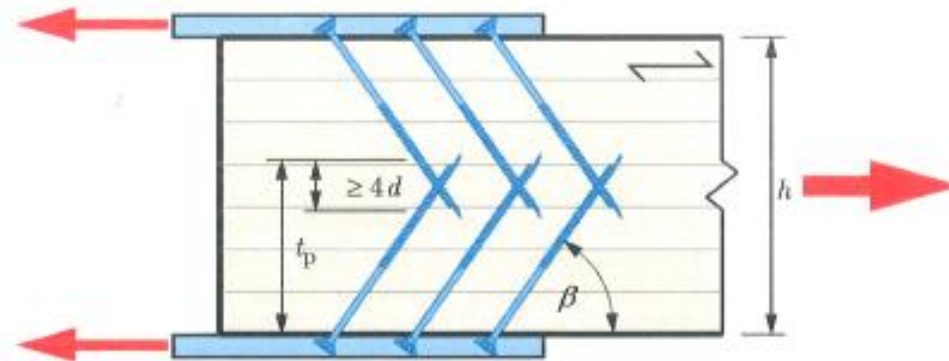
Mindestmaß für die gegenseitige Überlappung von Schrauben in Trägerachse unter Abzug der Schraubenspitzen
